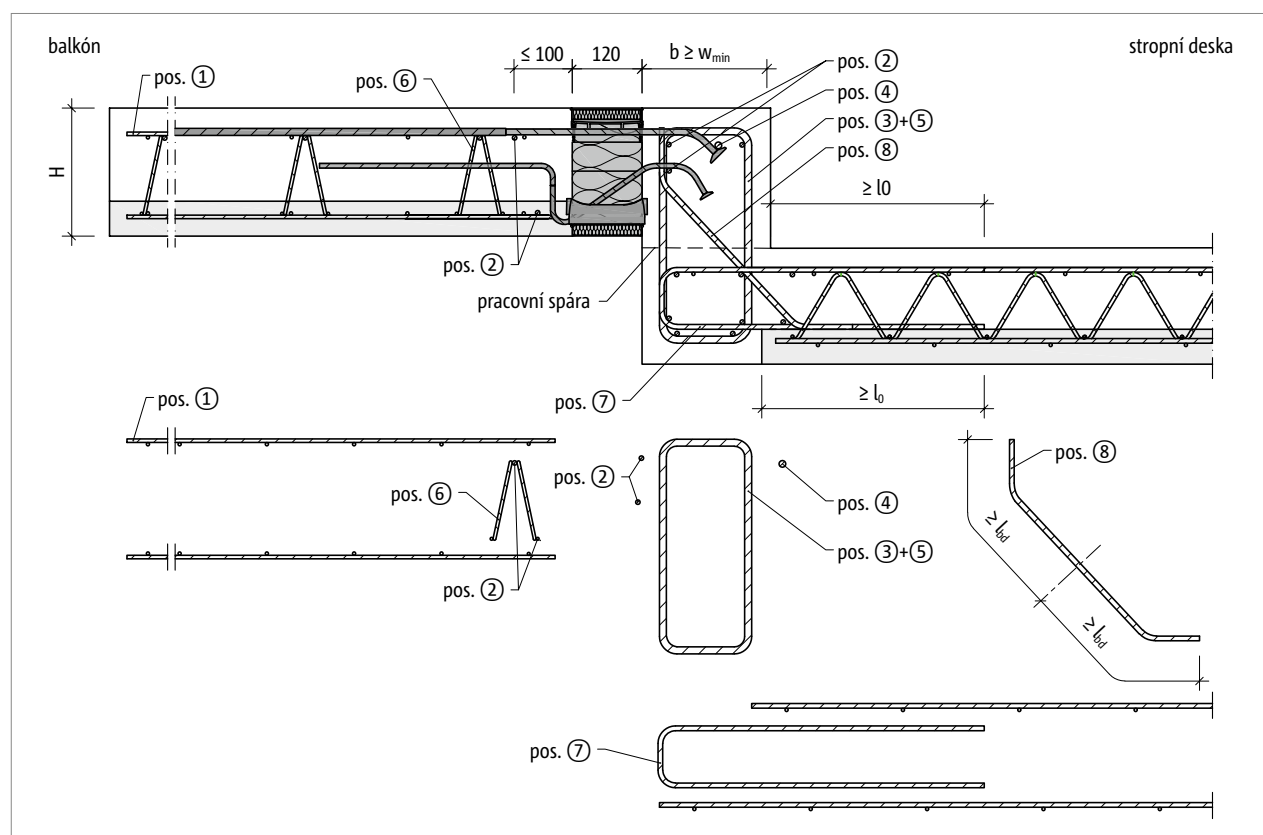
Schöck Isokorb® XT typ KL-O-F: Napojovací stavební výztuž pro desku kotvenou do stěny pod úroveň balkónu
